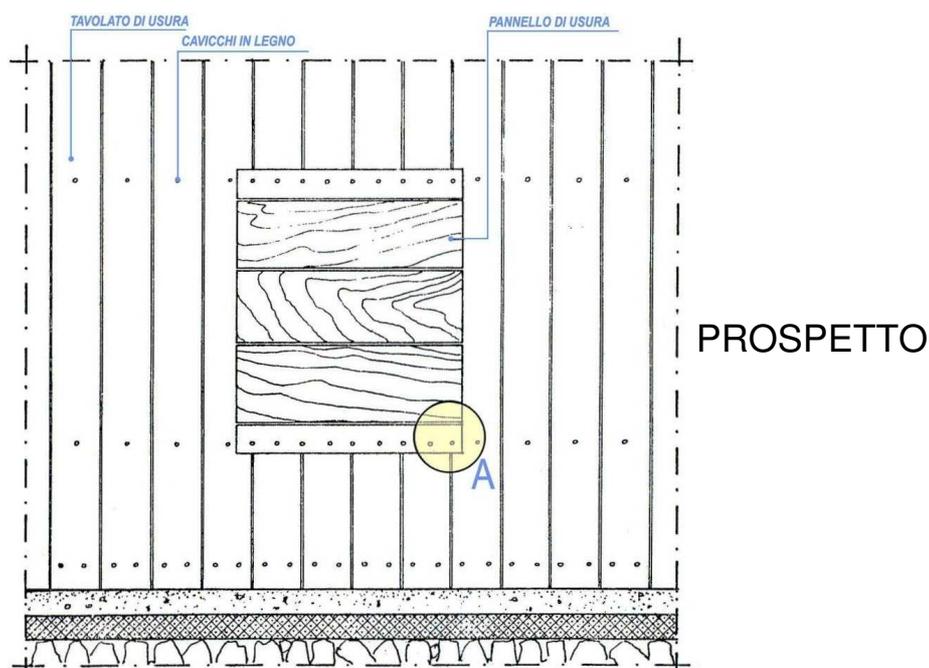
Vista frontale di un parapalle tradizionale in muratura, con rivestimento in legno
